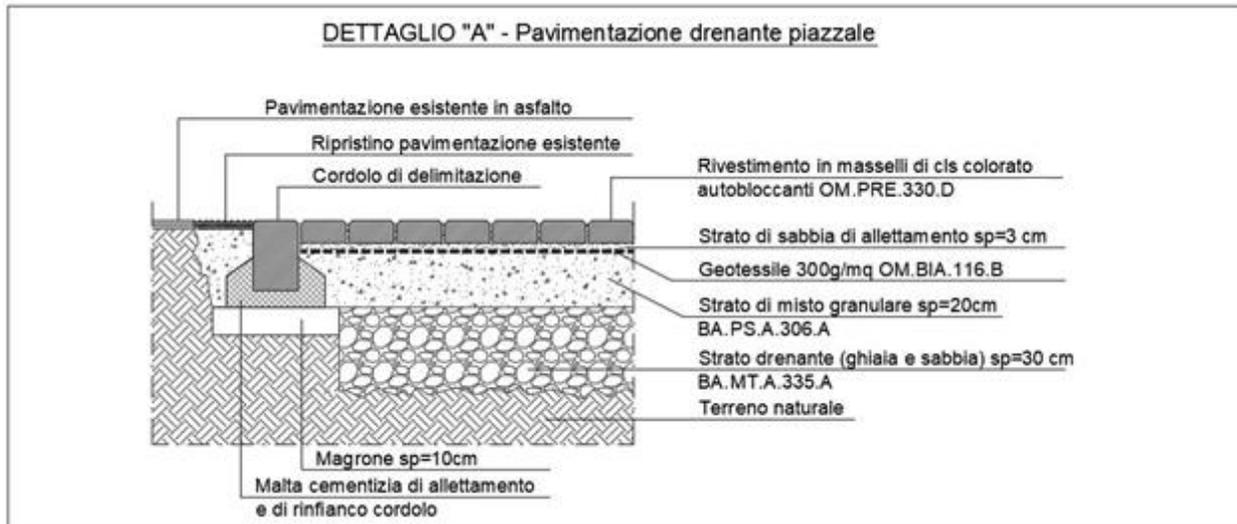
FA02 - Pavimentazione drenante del piazzale
